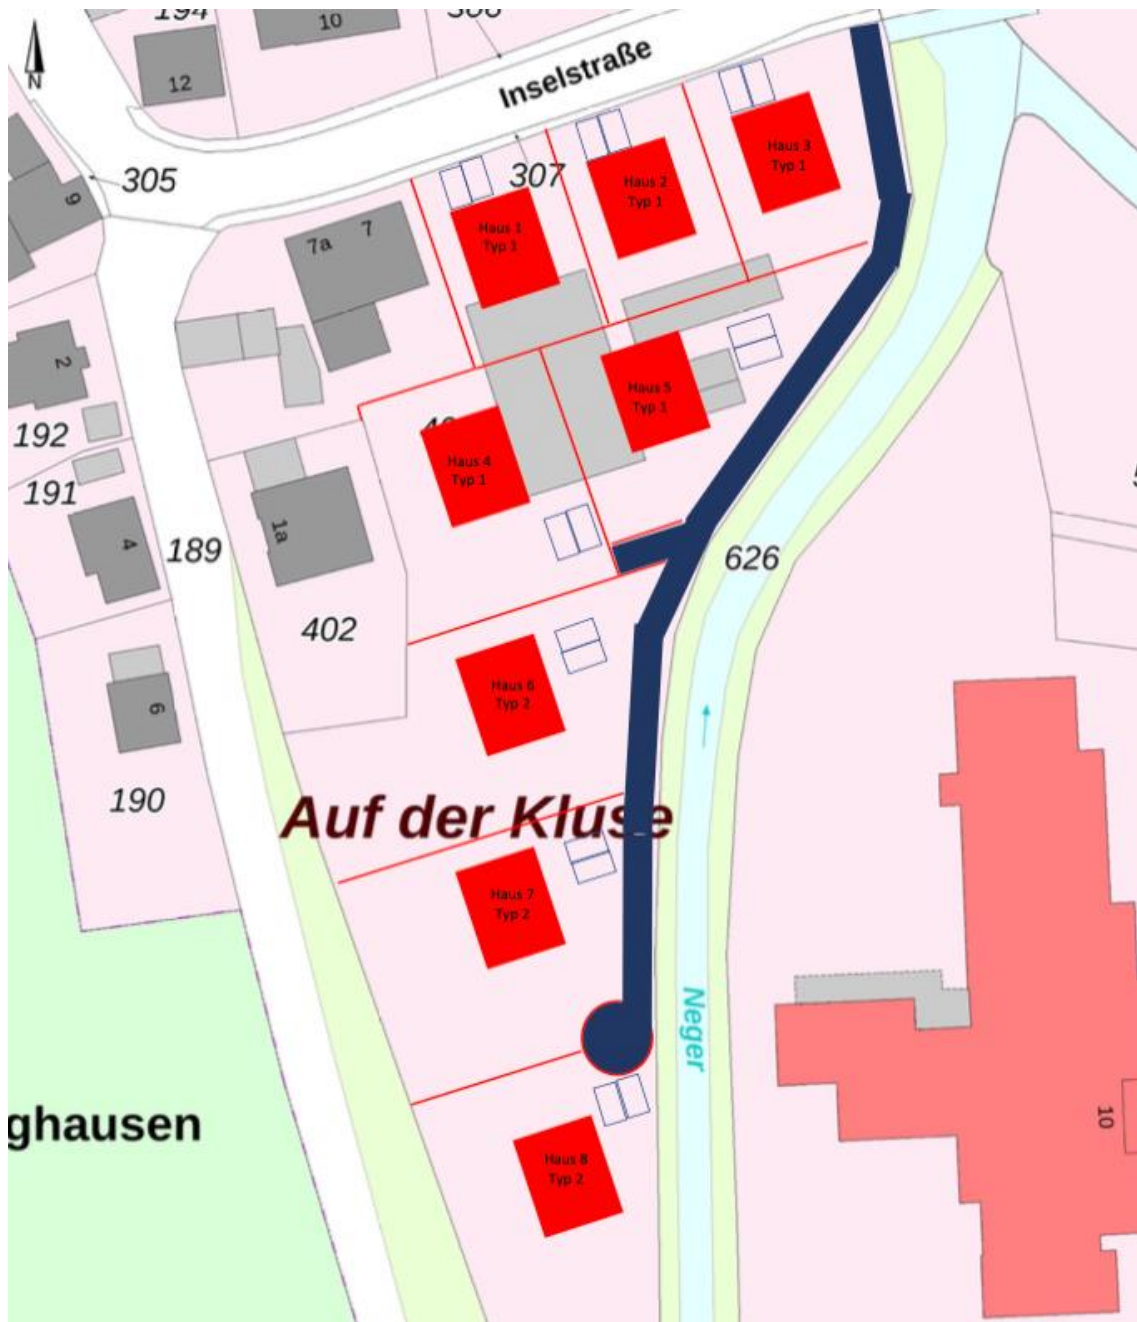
Lageplan zur Errichtung der Holzhäuser. Quelle: NETTEN 2022
